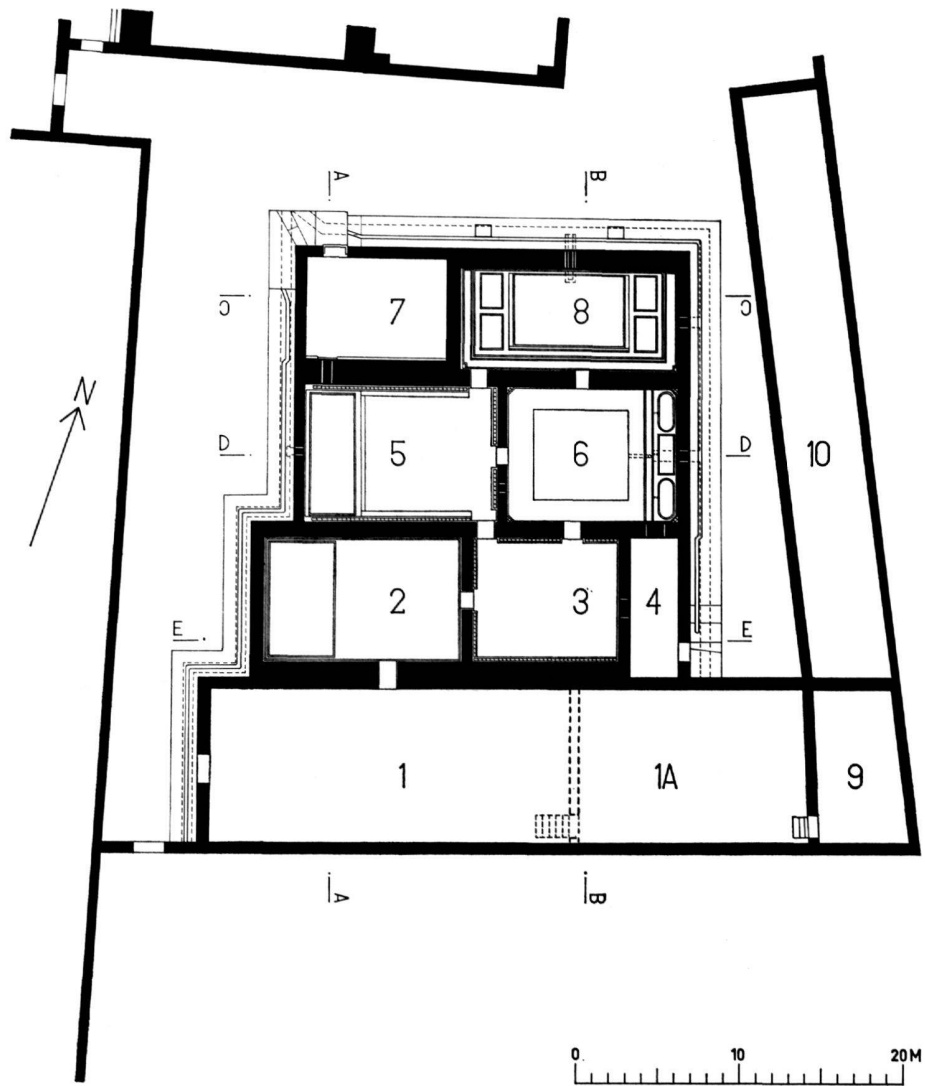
Augst. Grienmatt, Rekonstruktion, Grundriss mit Badeeinbauten.
